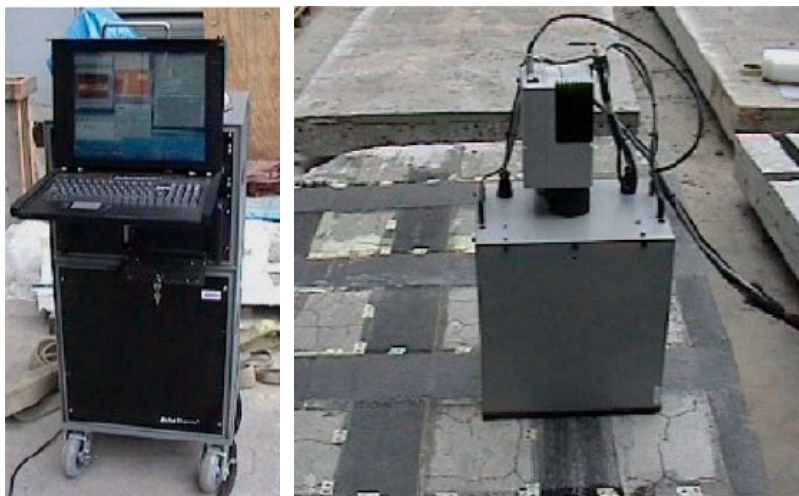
Equipamento para o ensaio (NCHRP Report 564, 2006).
